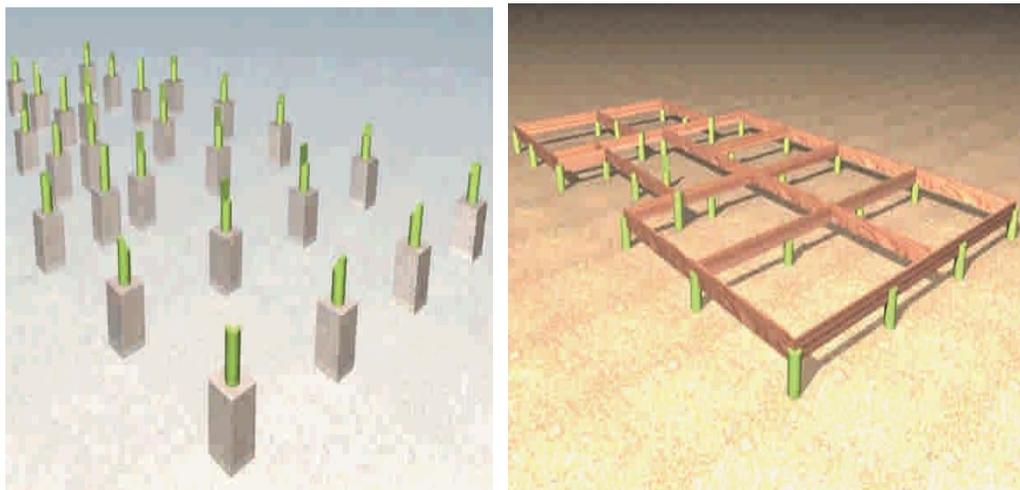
Pilas de concreto con pilotes de madera formando la base del piso.
